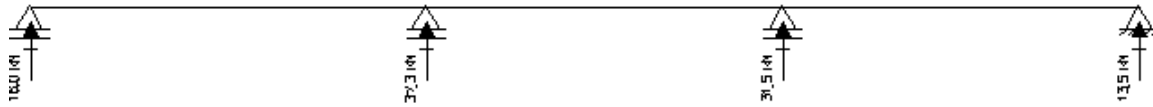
Reações de apoio devido às cargas sobre a viga 1.
